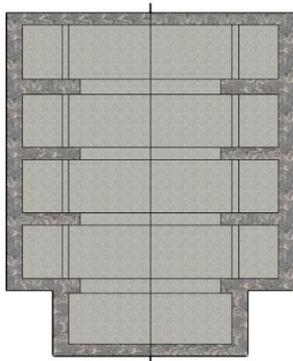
Interpretación planta Iglesia Catí en 1503
